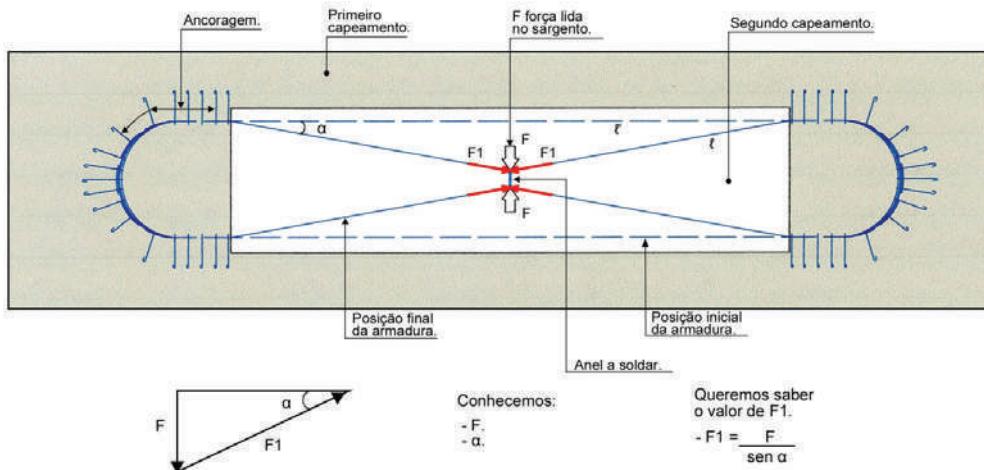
A junção das armaduras ou pinçamento alonga a armadura e dá a tensão requerida. (*-5).
